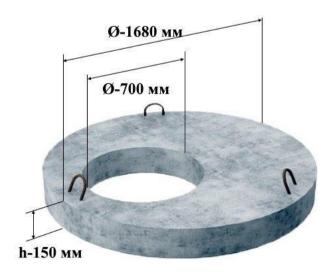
Крышка колодцев железобетонная ПП-15
